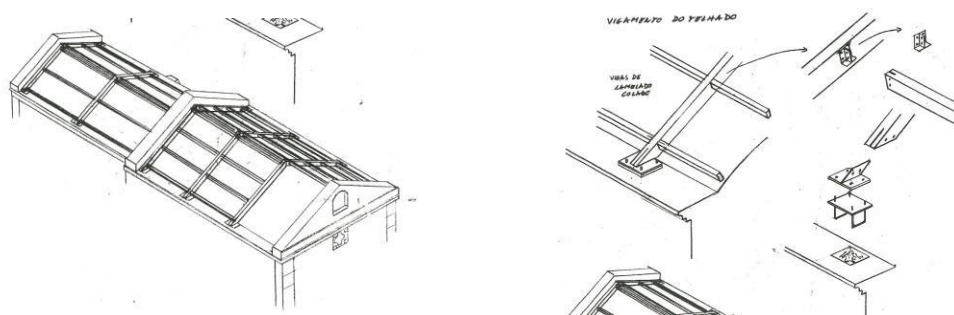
Desenhos da construção da estrutura do telhado e pormenores das ligações. (Doutor Arq. Jorge Mascarenhas) [4]
